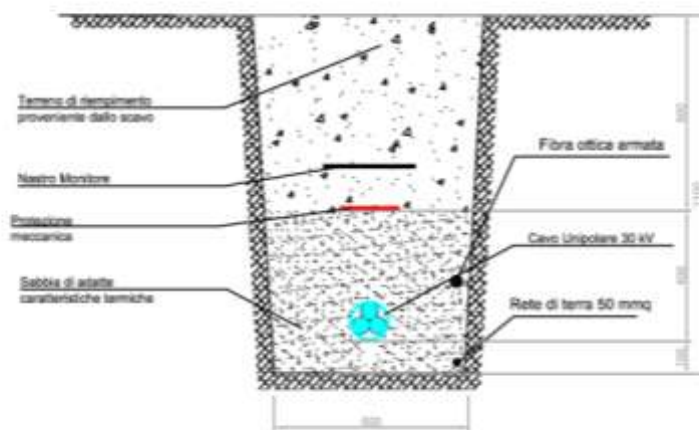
Sezione tipica di posa della linea in cavo su strade sterrate (Tipo 1A)
